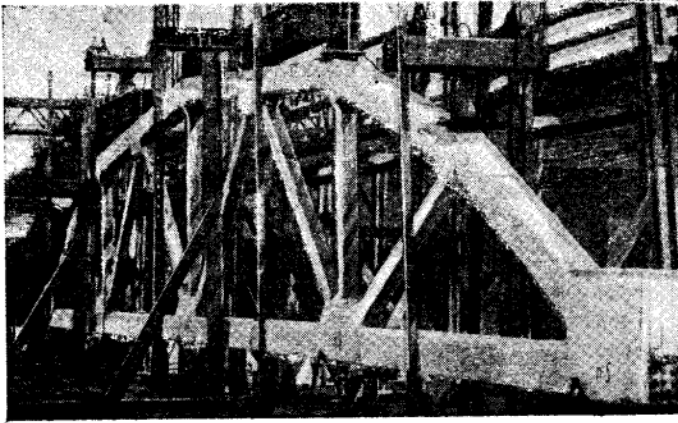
Испытание сегментных ферм пролетом 24 м из аглопоритобетона марки 400 на Минском заводе СЖБ № 1
